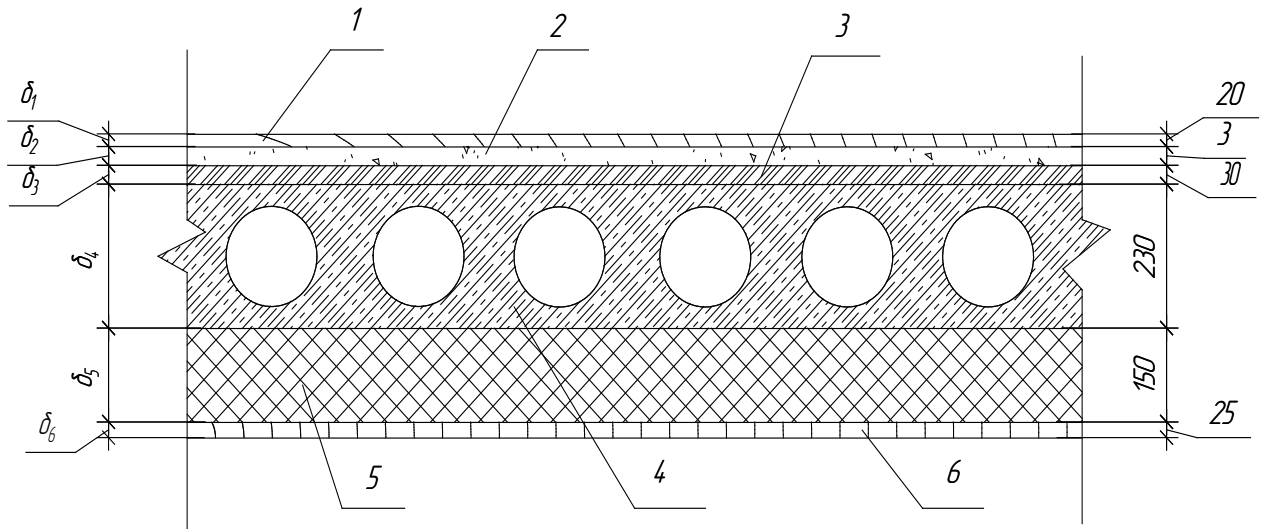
Схема до розрахунку перекриття над підвалом на знаходження термічного опору: 1 – паркет дубовий; 2 – цементна стяжка; 3 – гідроізоляція; 4 – з/б плита; 5 – утеплювач ; 6 – обшивка.
